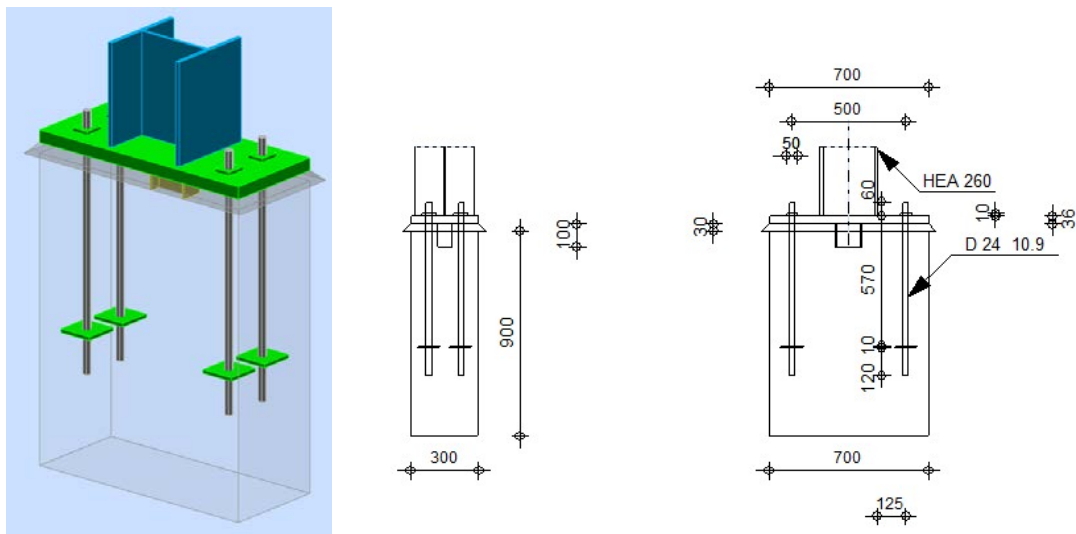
Vista 3D e Pormenores da Ligação de Encastramento do Pilar P2
